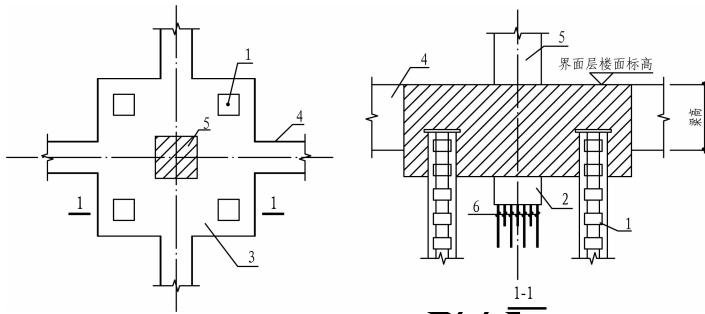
上下同步逆作施工时界面层转换结构布置
